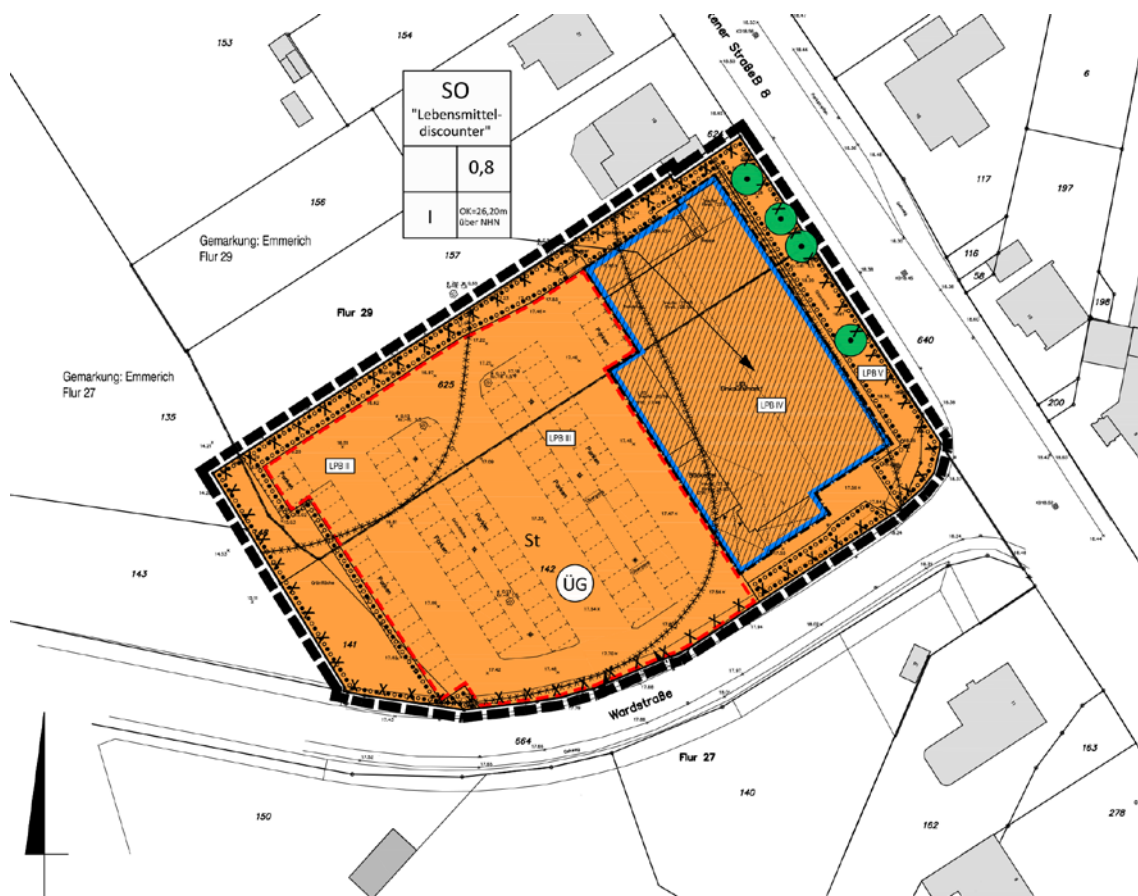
Lage des Bebauungsplanes E27/3 der Stadt Emmerich am Rhein mit seinen zeichnerischen Festsetzungen (Quelle: Stadt Emmerich am Rhein)
